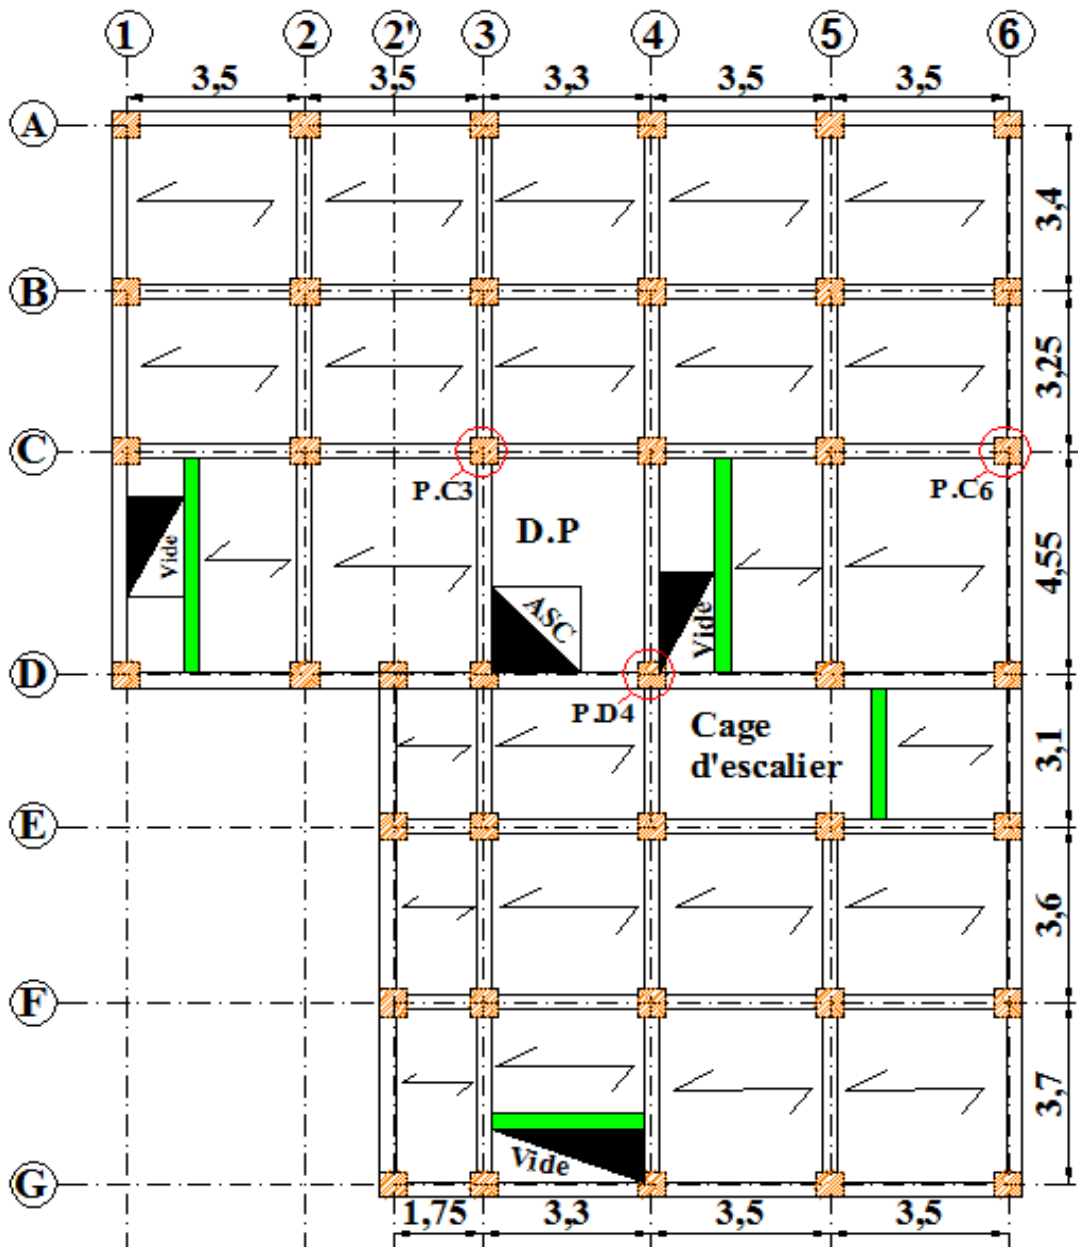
Plan de disposition des poutrelles (Étage Entresol).
